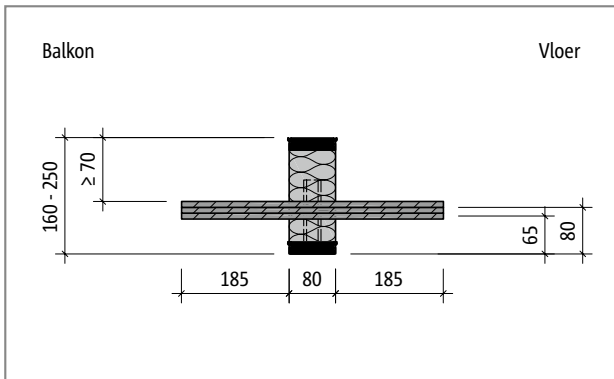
Schöck Isokorb® T type H-NN1: Bovenaanzicht
